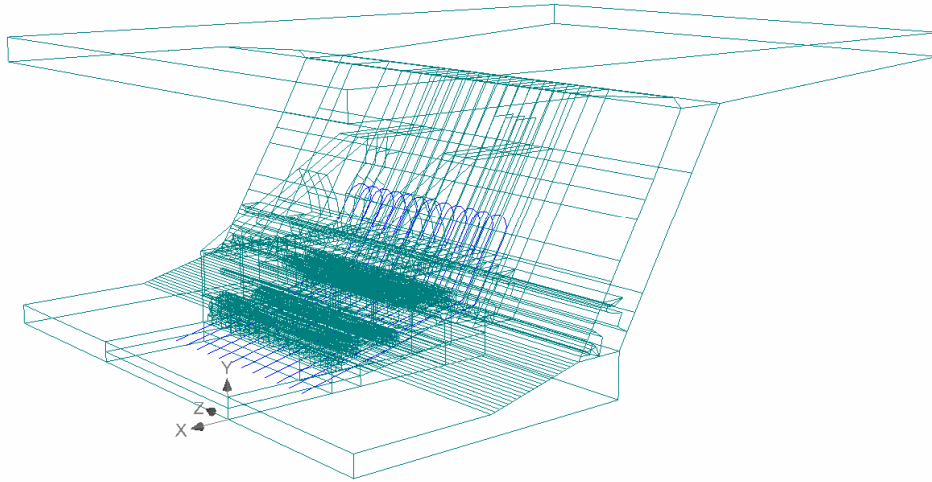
Bewehrung Pos.1 und Pos.4, Ø22 mm
